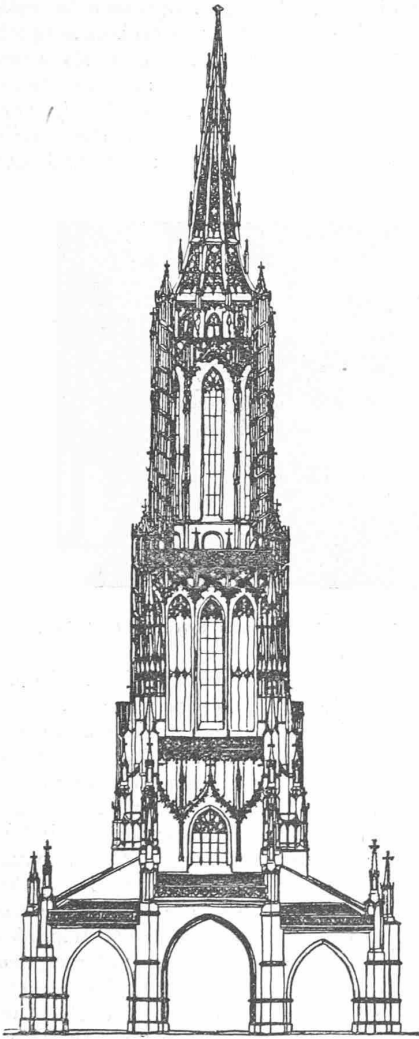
Berner Münsterturm nach Ensingers Strassburger-Riss (1400). Rekonstruktion InderMühle.
